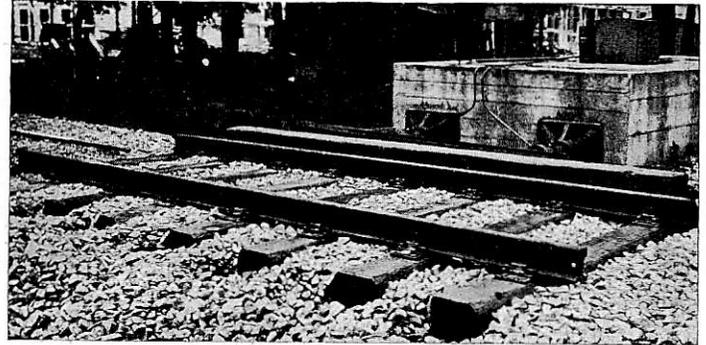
Gleis mit freigelegten Schwellenköpfen.
